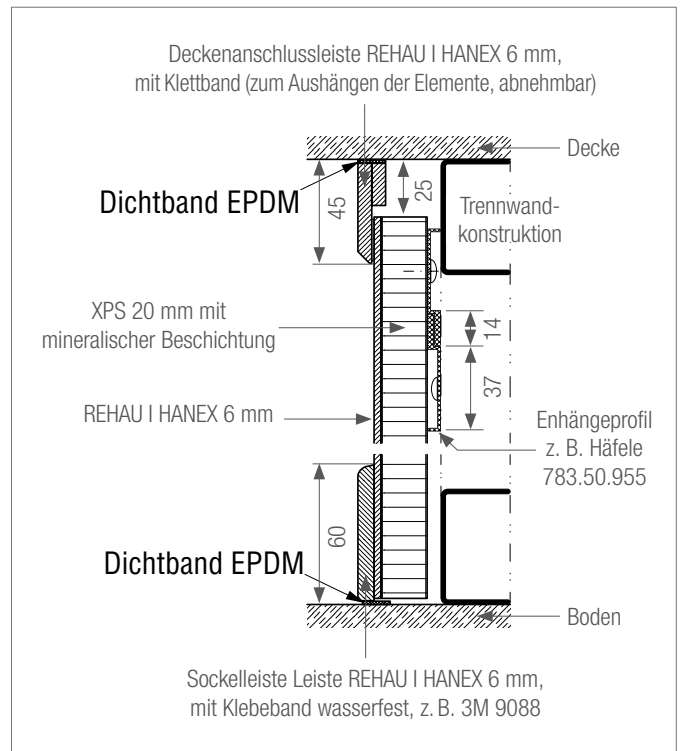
Schnitt Elemente auf Trennwandkonstruktion
